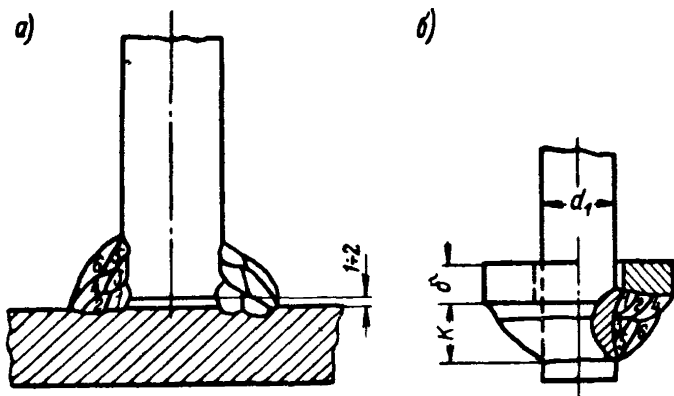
Конструкции тавровых соединений стержней класса А-IV с плоскими элементами проката, выполняемых ручной дуговой сваркой многослойными швами
